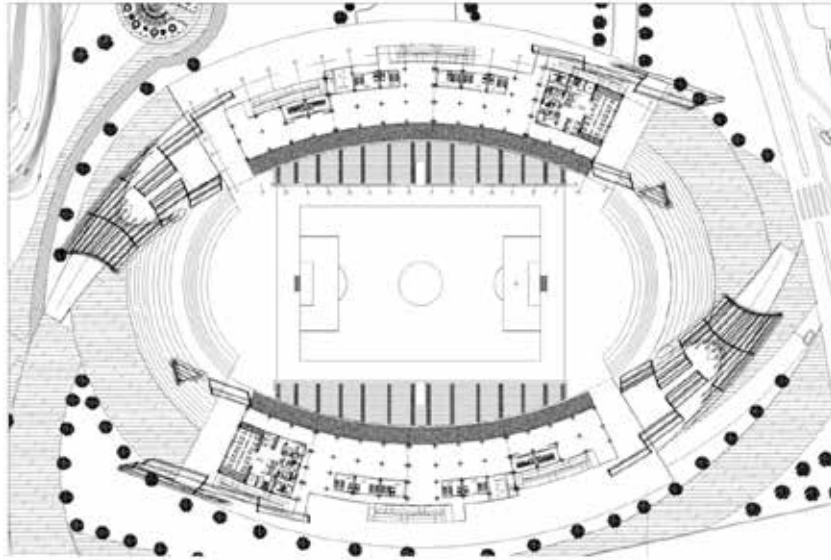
Planta Nivel +11.76, Planta Restaurant.
